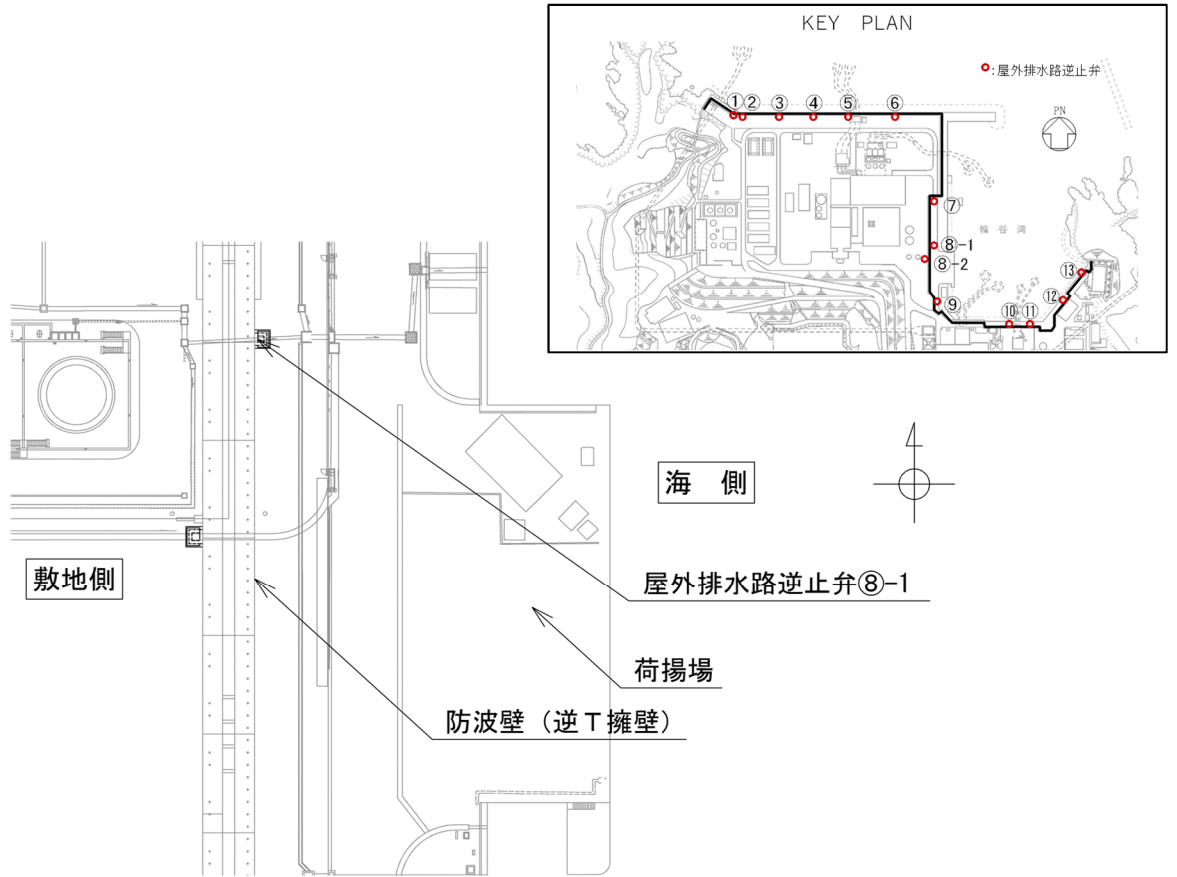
(1) 屋外排水路逆止弁⑧-1 平面图
